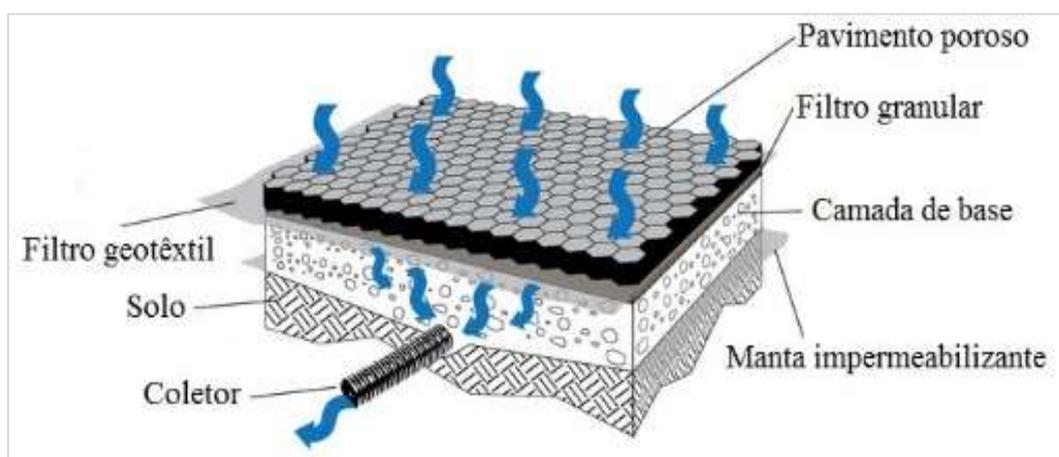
Estrutura de um pavimento poroso com ligação ao sistema de drenagem
